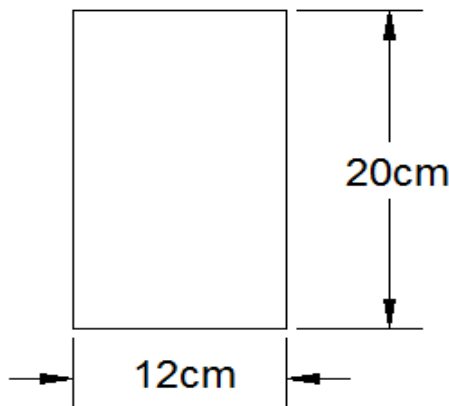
coupe schématique de la poutrelle (appuis).
